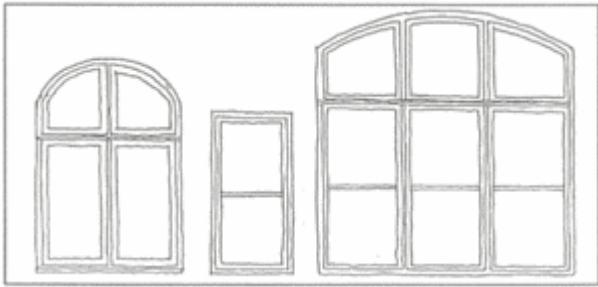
Facadevinduer: Køkkenvindue på 1.sal, køkkenvindue i stueetagen, ventilationsvindue. Ventilationsvinduet ud mod gården øverst i midtereksemplet kan evt. være tophængt.
